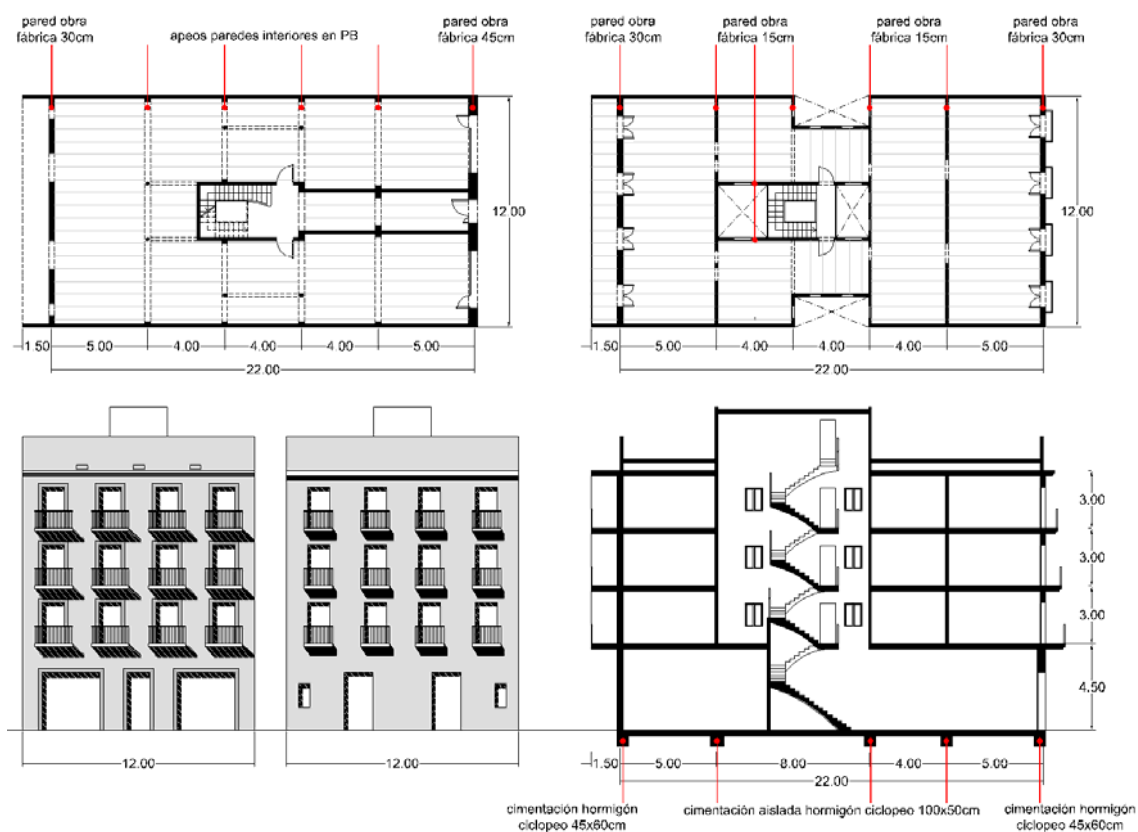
d Plantas, alzados y secciones del modelo II.3
